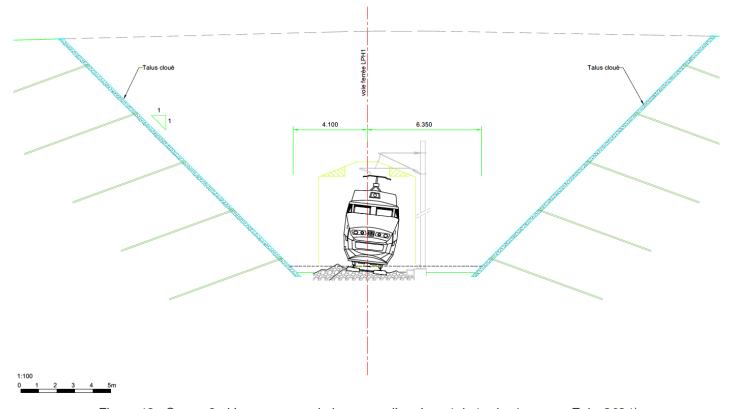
Coupe 3 - Vue en coupe de la rampe d'accès est du terrier (source : Egis, 2021)
